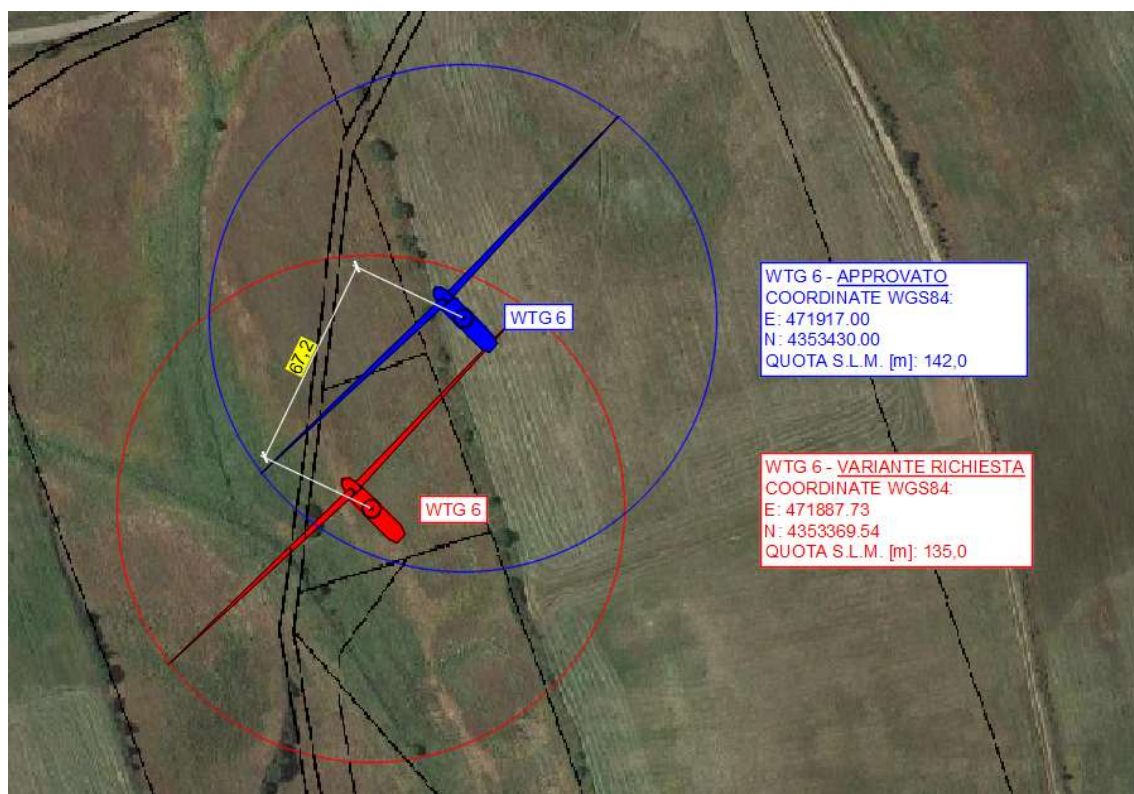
Confronto posizione WTG 6 tra progetto approvato e progetto in variante
